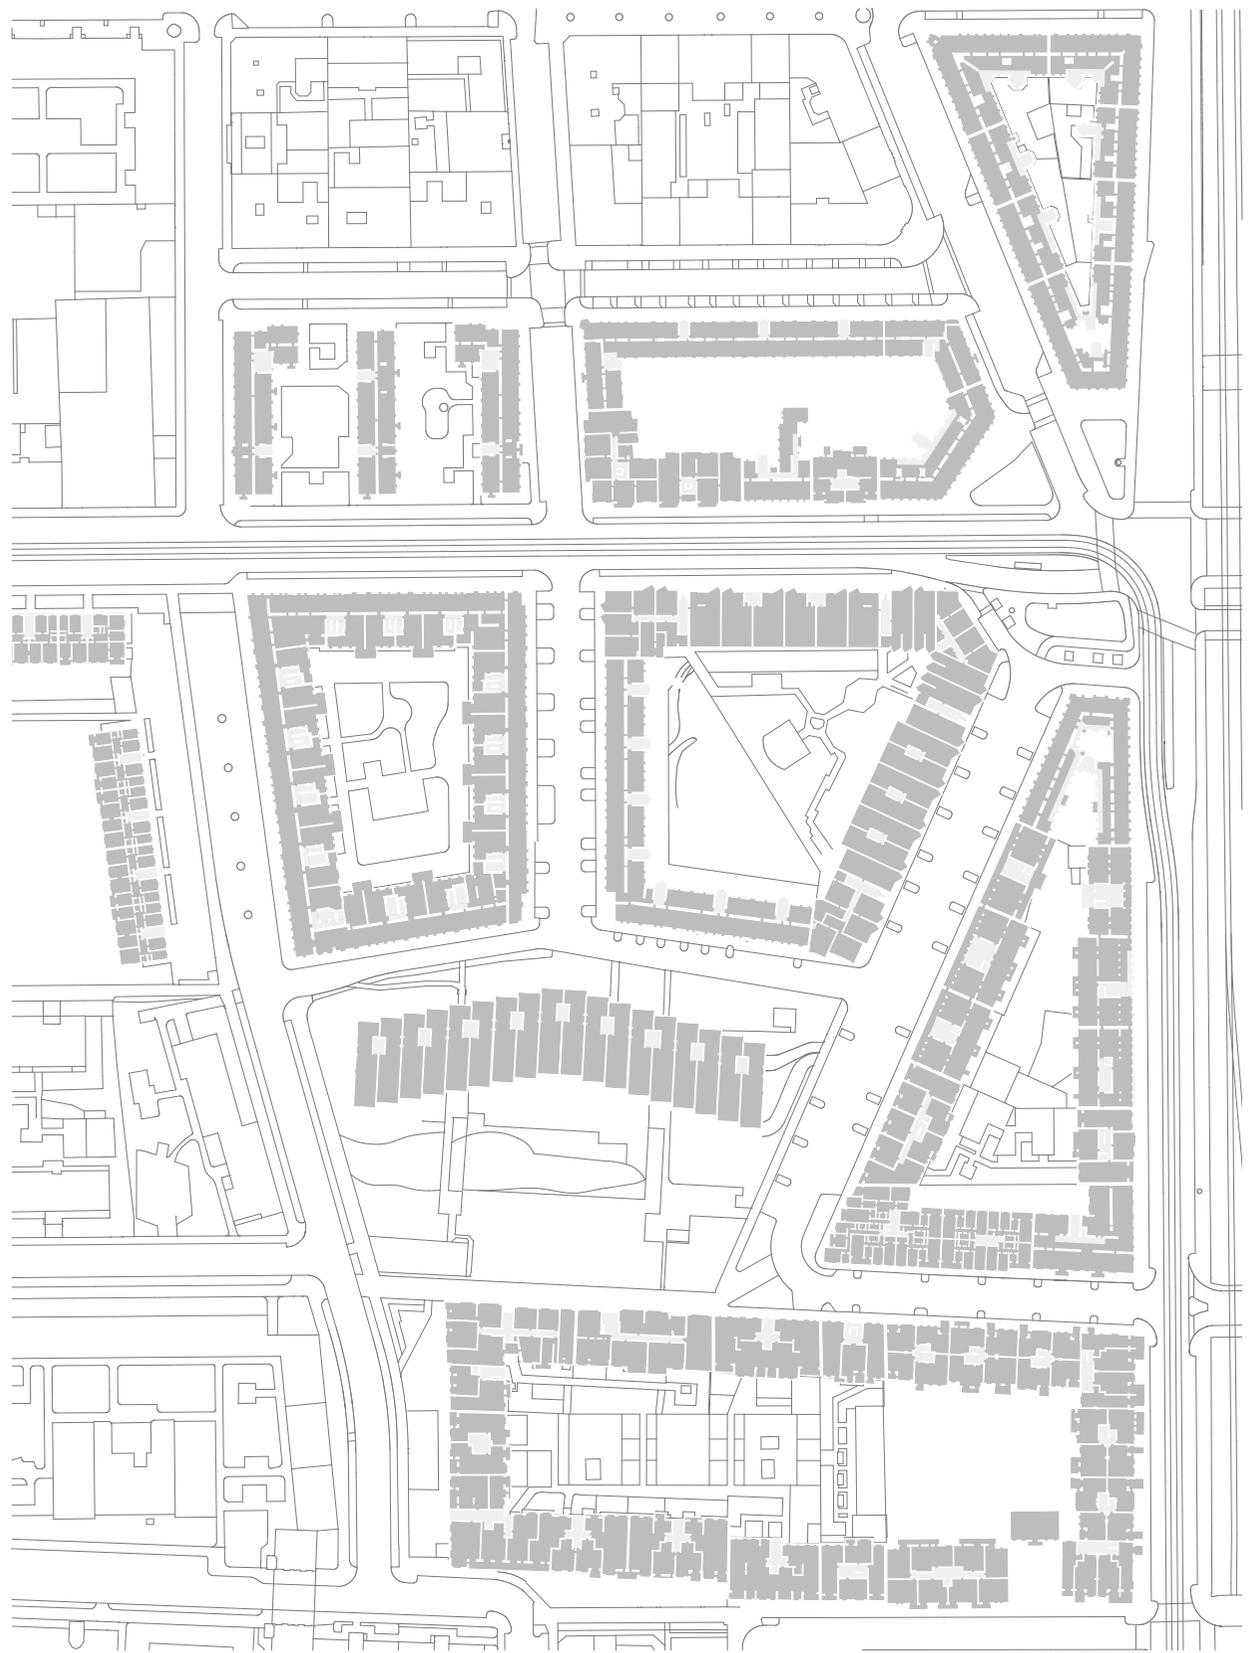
Lageplan komplementäre Möglichkeiten, 1:2000
